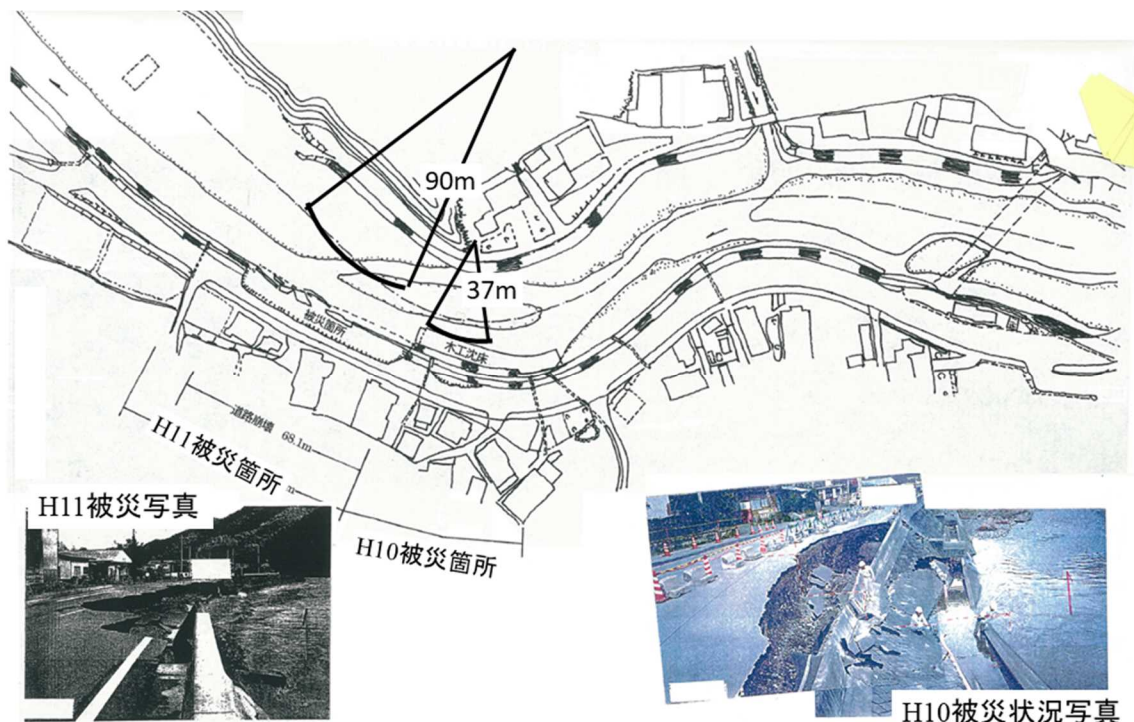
道路兼用護岸の基礎吸出し破壊事例平面図 洪水規模による水衝部変化
